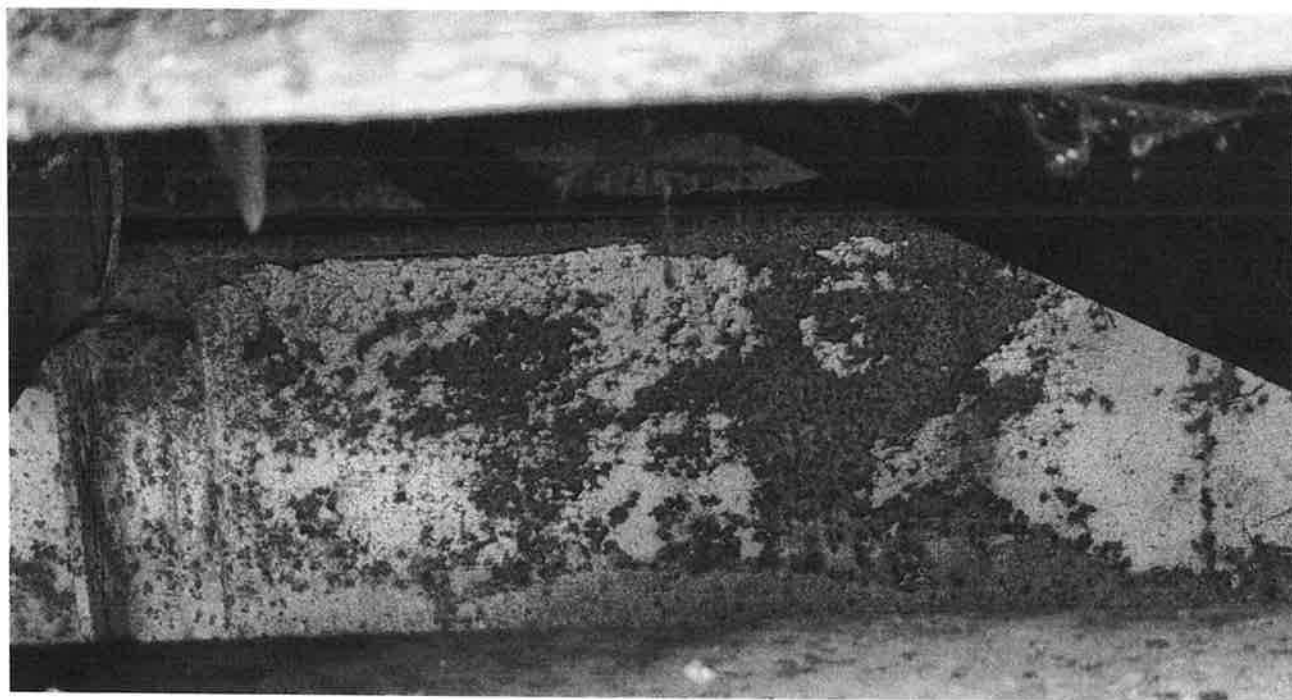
Liniowe ubytki betonu w filarze, spowodowane erozyjnym działaniem wody
